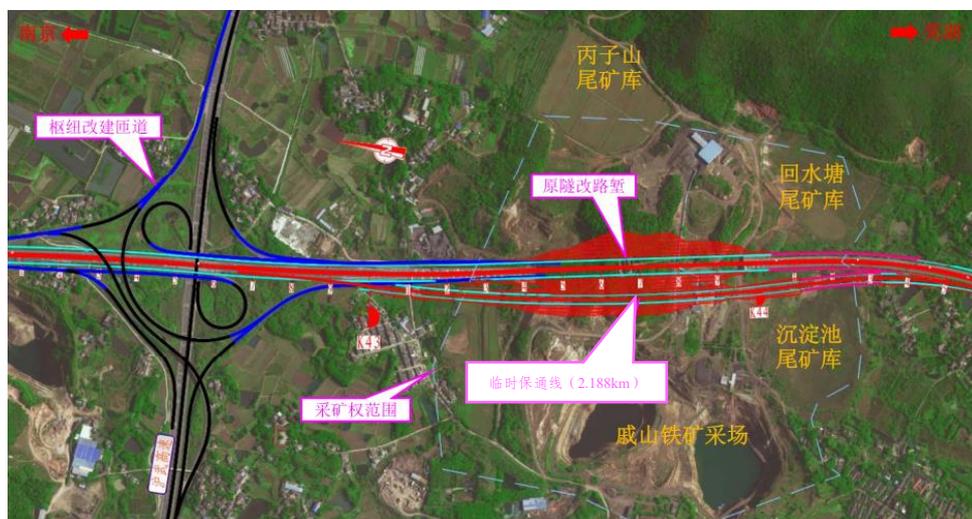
“新建保通线+原隧改路堑”平面图
